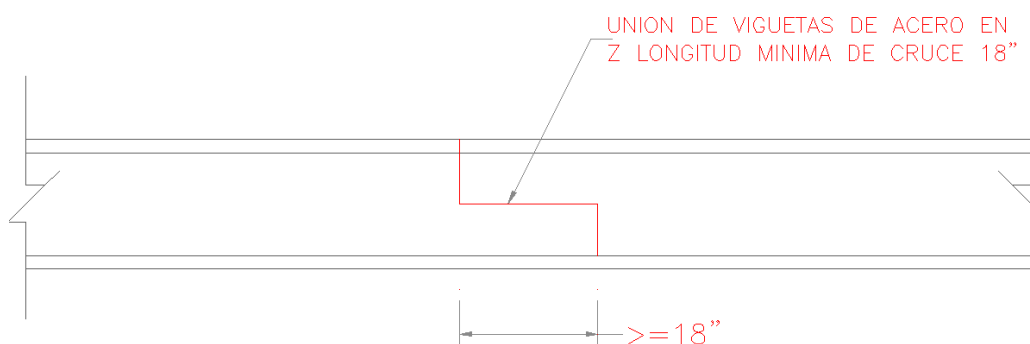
Unión de viguetas para formar V-1, V-2 y columnas C-1
